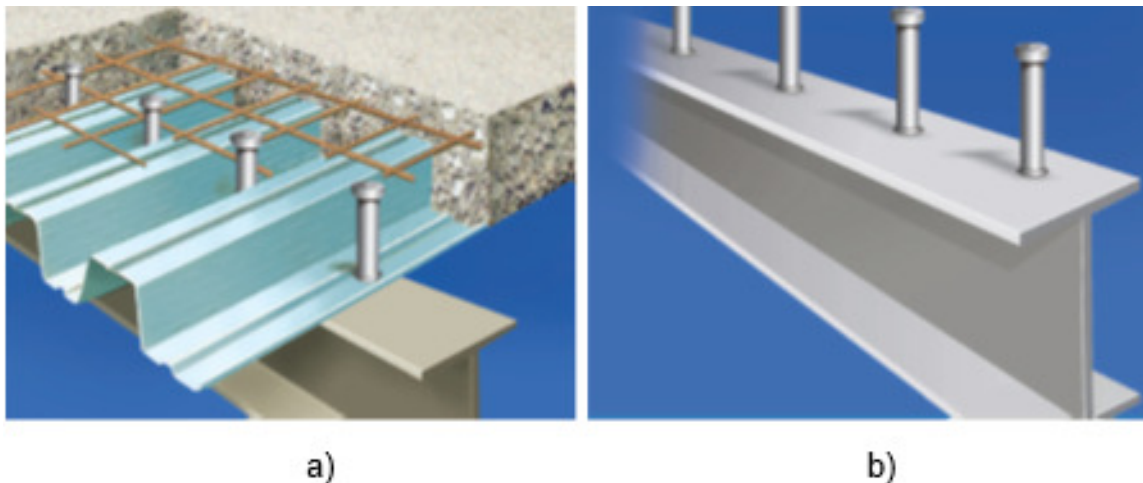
Soldagem de pinos em: a) steel deck, b) diretamente no perfil (pagina ciser, 2013).
